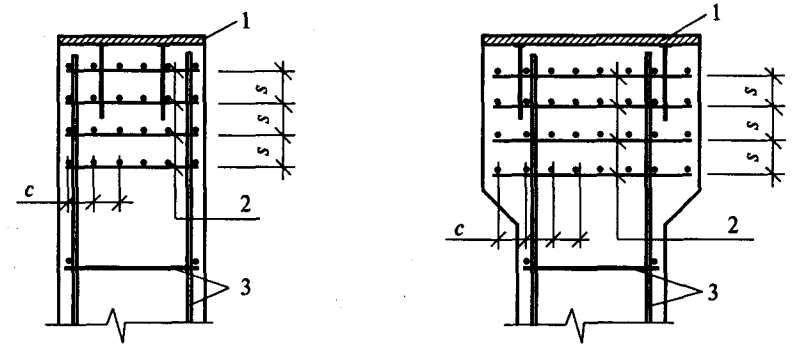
Армирование оголовков колонн: а) конструкция оголовка без уширения опорной части; б) конструкция оголовка с уширением опорной части; 1 — закладная деталь; 2 — арматурные сетки; 3 — каркас колонны;  $s$  — шаг сеток, принимают  $\geq 60$  мм;  $\leq 1/3 h$  ( $h$  — меньший размер сечения);  $\leq 150$  мм;  $c$  — размер ячеек сетки, принимают  $\geq 45$  мм;  $\leq 1/4 h$ ;  $\leq 100$  мм
